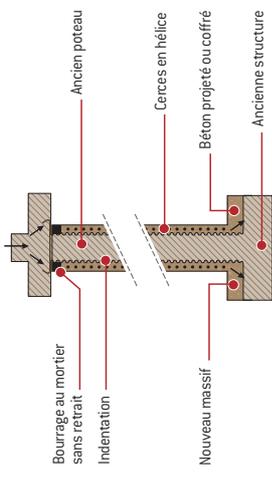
Chemisage en béton armé d'un poteau - fondation renforcée (coupe transversale)
